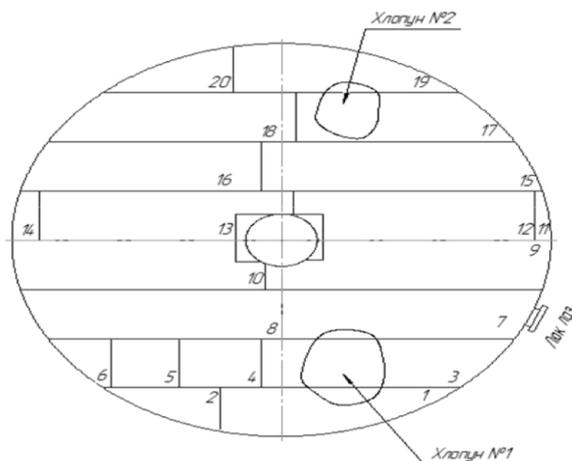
Карта-схема расположения дефектов формы и листов днища резервуара РВС-1000 м
